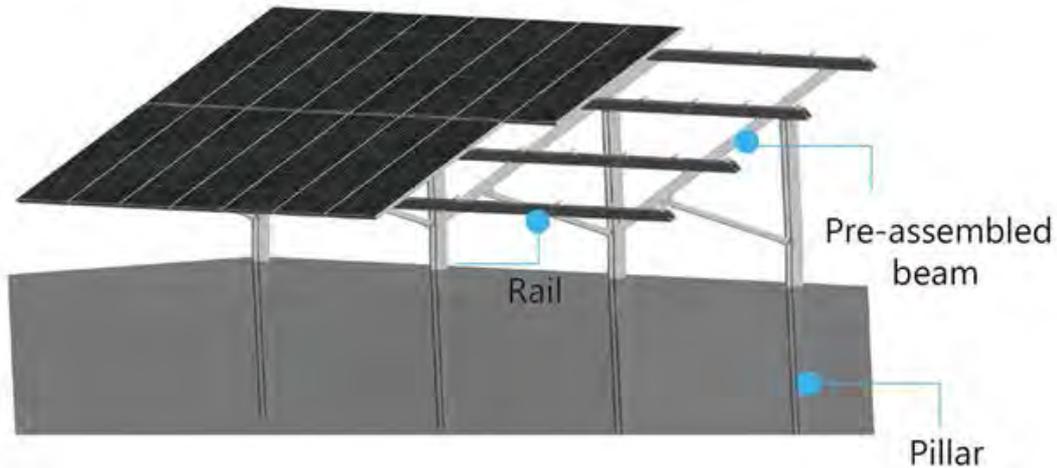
Modelo ejemplo de estructura de soporte de las placas al suelo - *Pile Ground Mounting System
